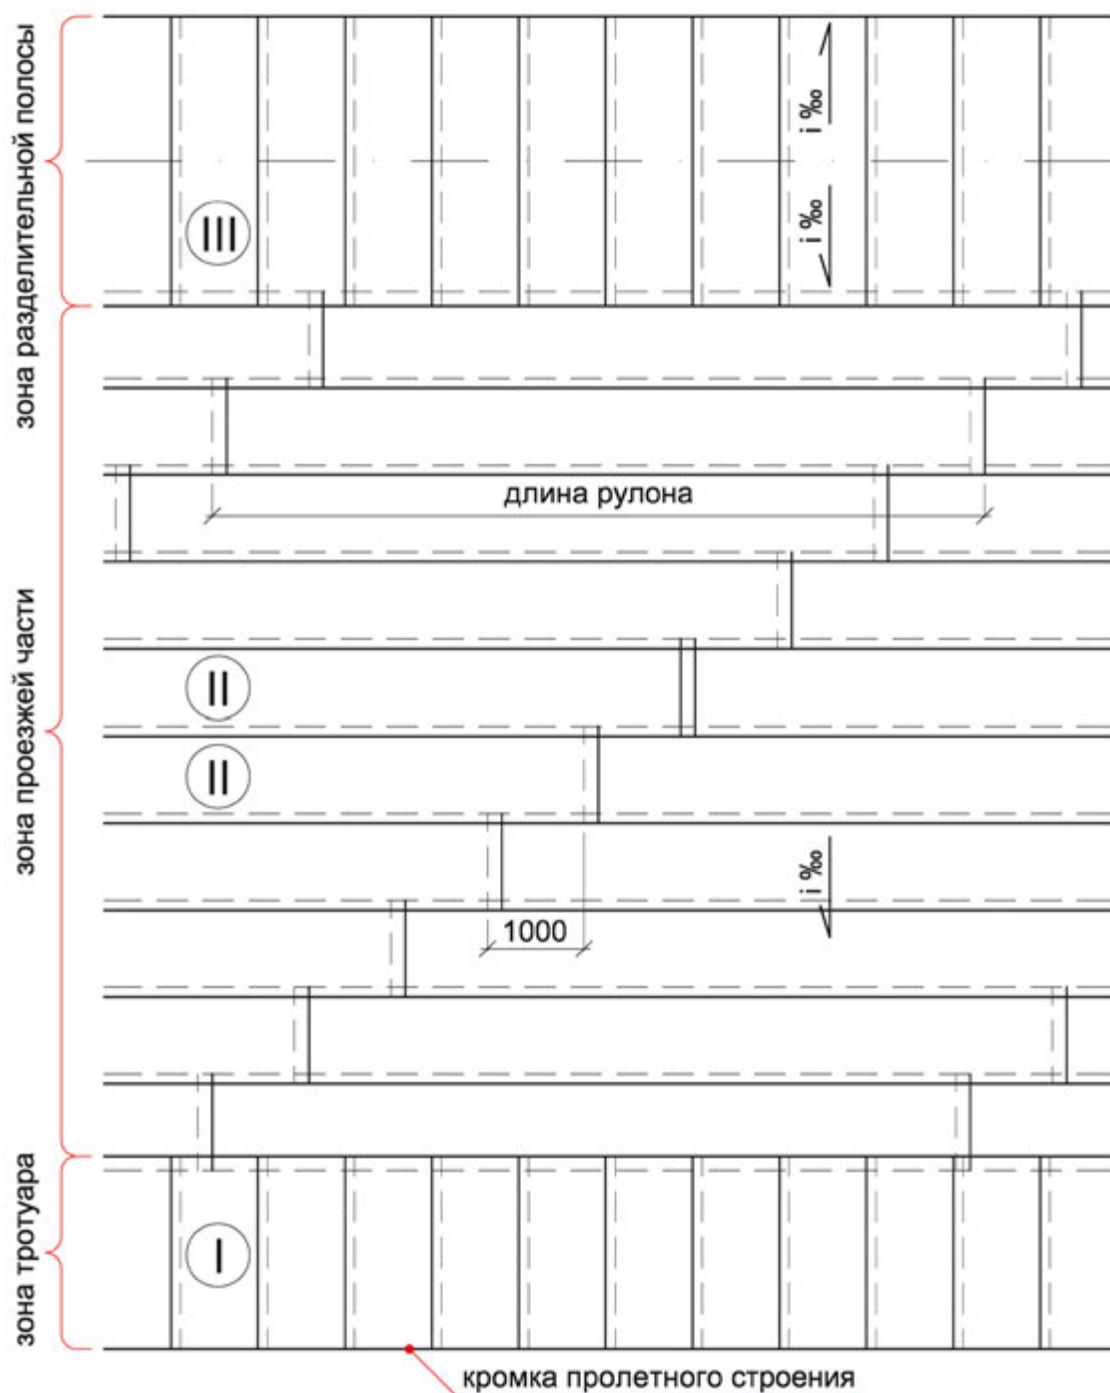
Схема наплавления рулонных гидроизоляционных материалов
